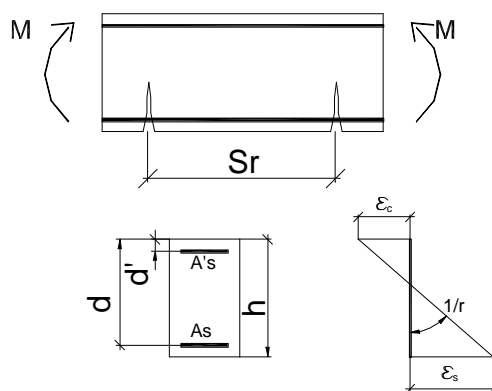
Peça fissurada de concreto armado.
